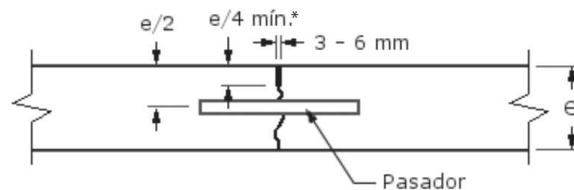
JUNTA TIPO A-1. JUNTA TRANSVERSAL DE CONTRACCIÓN CON PASADOR.
